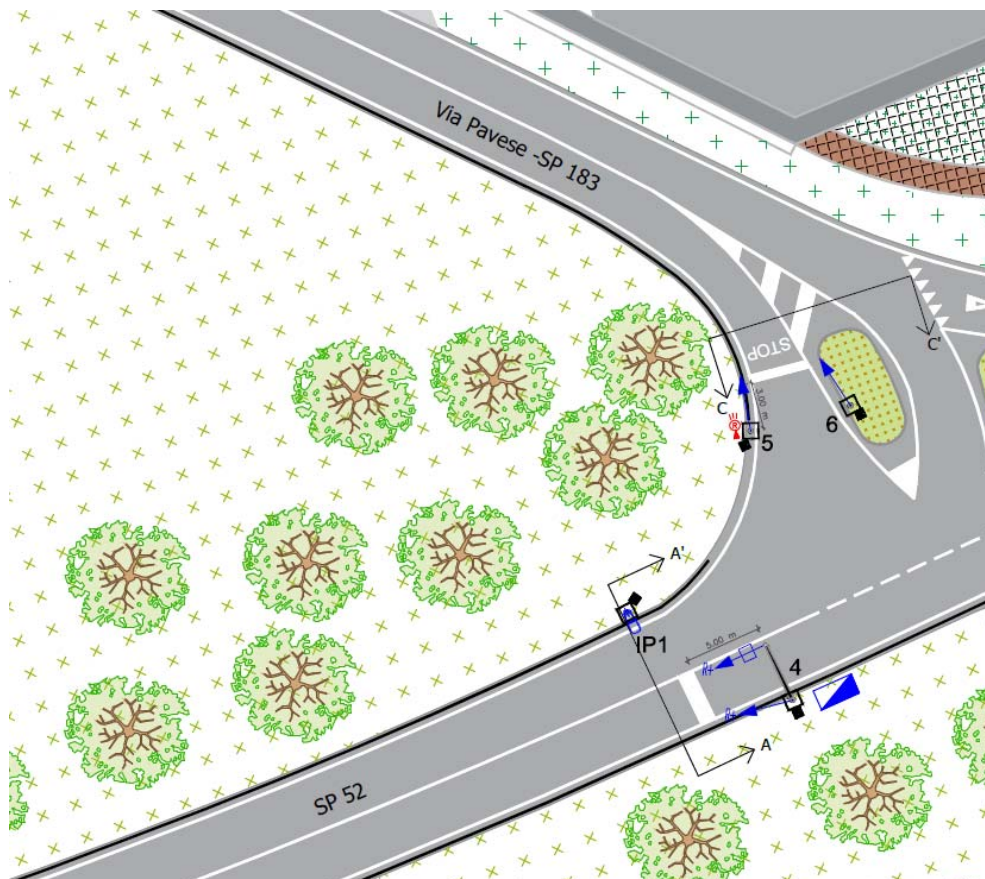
Dettaglio impianto semaforico SP 52/via Pavese
